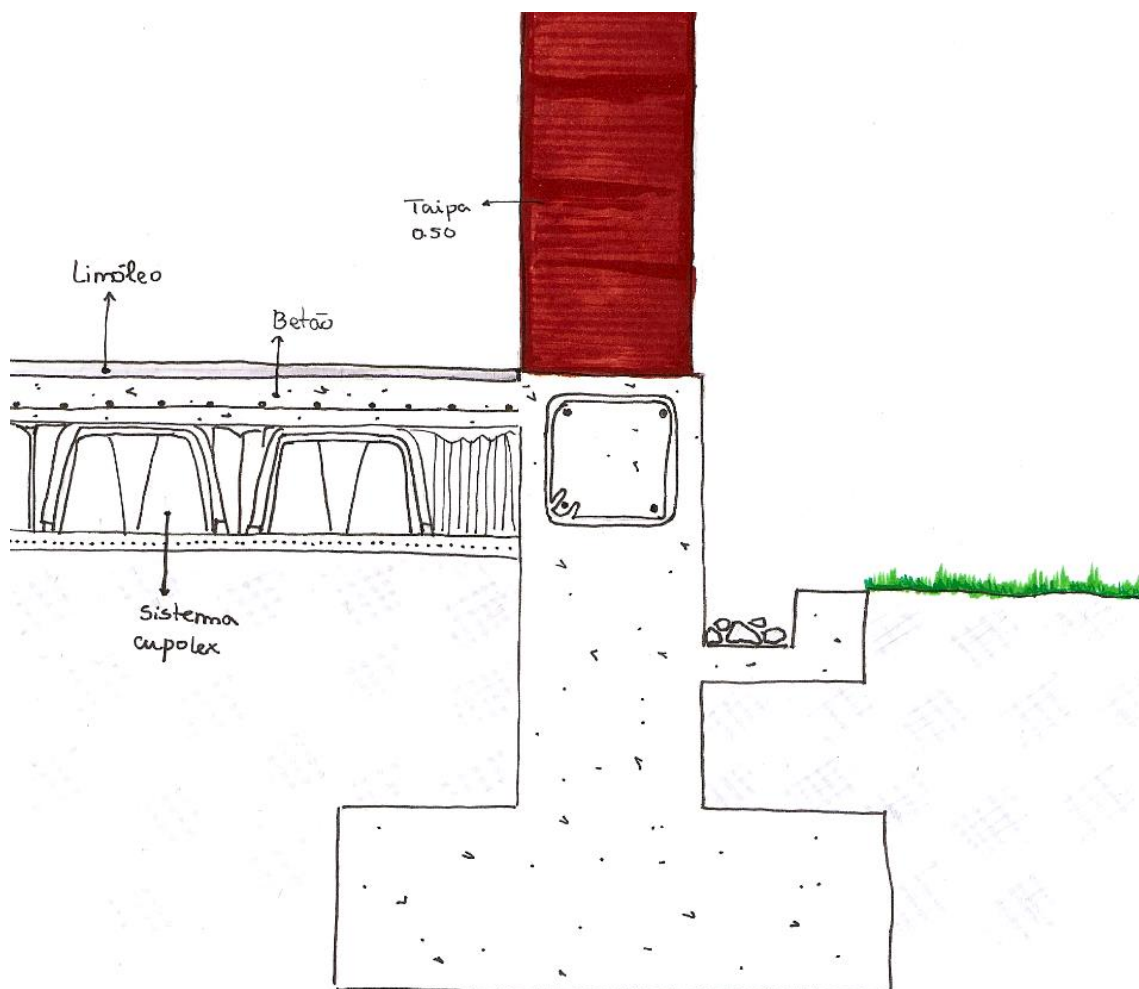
Pormenor Construtivo da Laje de Pavimento. (Sem Escala)
